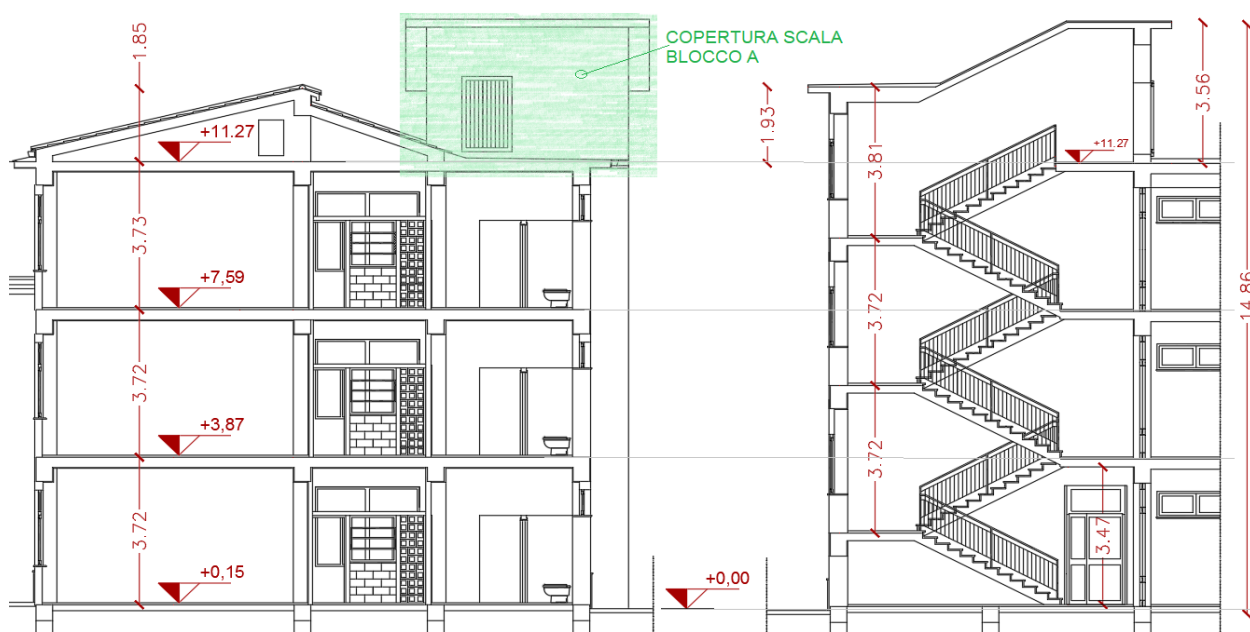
STRALCIO SEZIONE TRASVERSALE TIPO E SEZIONE LONGITUDINALE IN CORRISPONDENZA DEL VANO SCALA BLOCCO A
